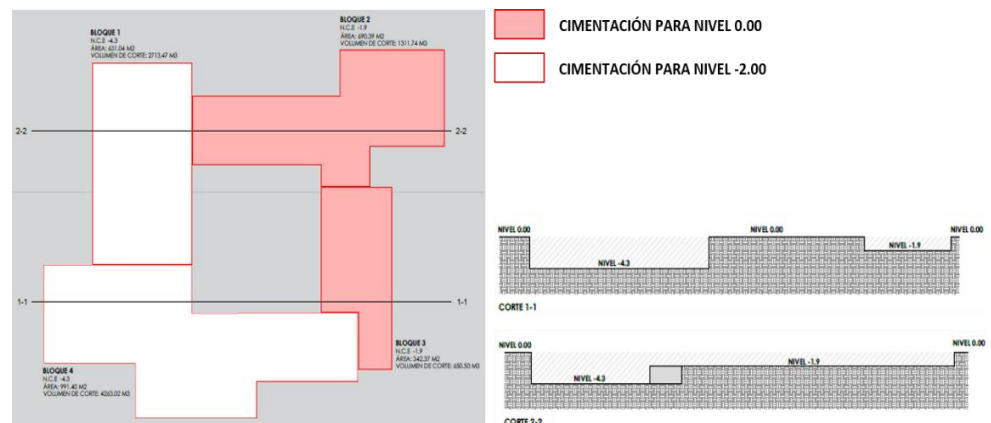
Esquema de cimentación. Fuente: Elaboración propia
